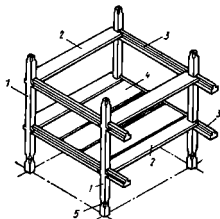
Сборный железобетонный унифицированный каркас:
